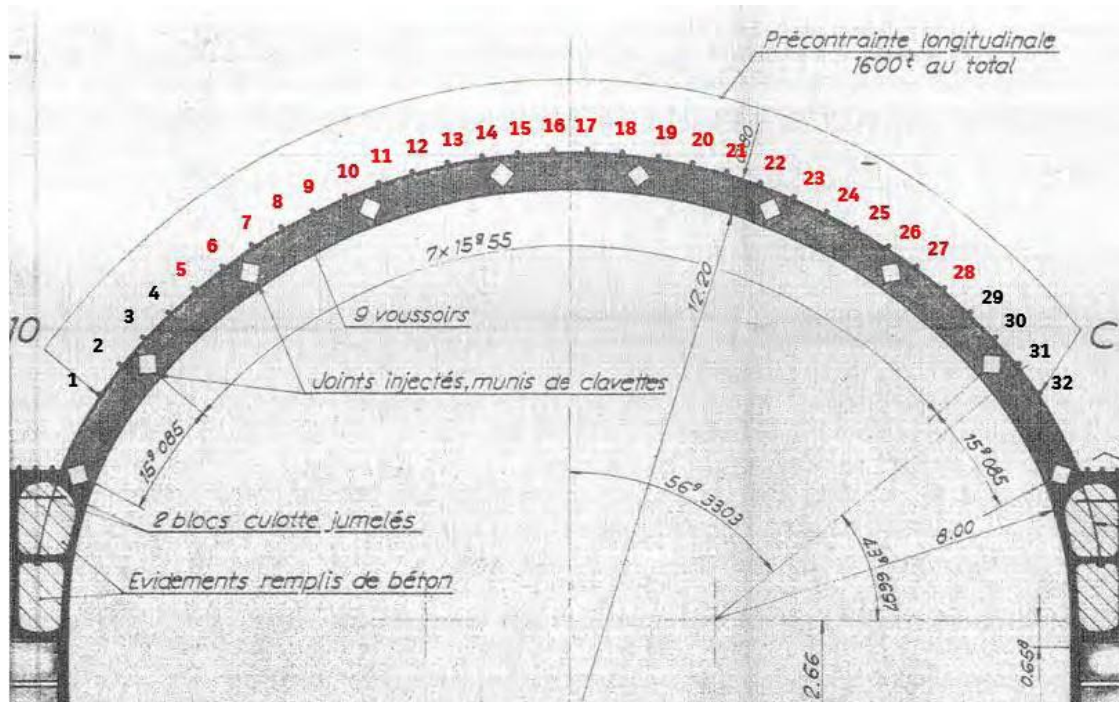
Section droite de la voute : câbles auscultables numérotés de 5 à 28.
